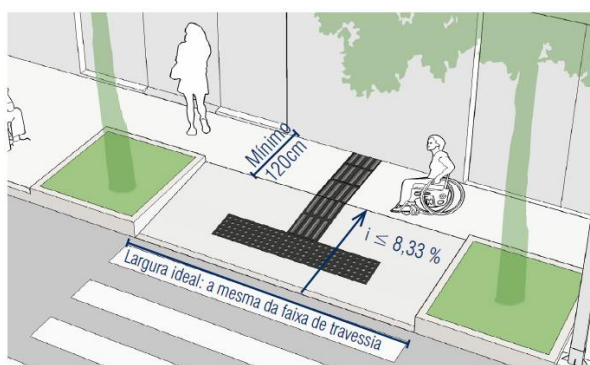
RAMPA PARA CALÇADAS COM 3 METROS DE LARGURA OU MAIS COM CANTEIROS LATERAIS.
